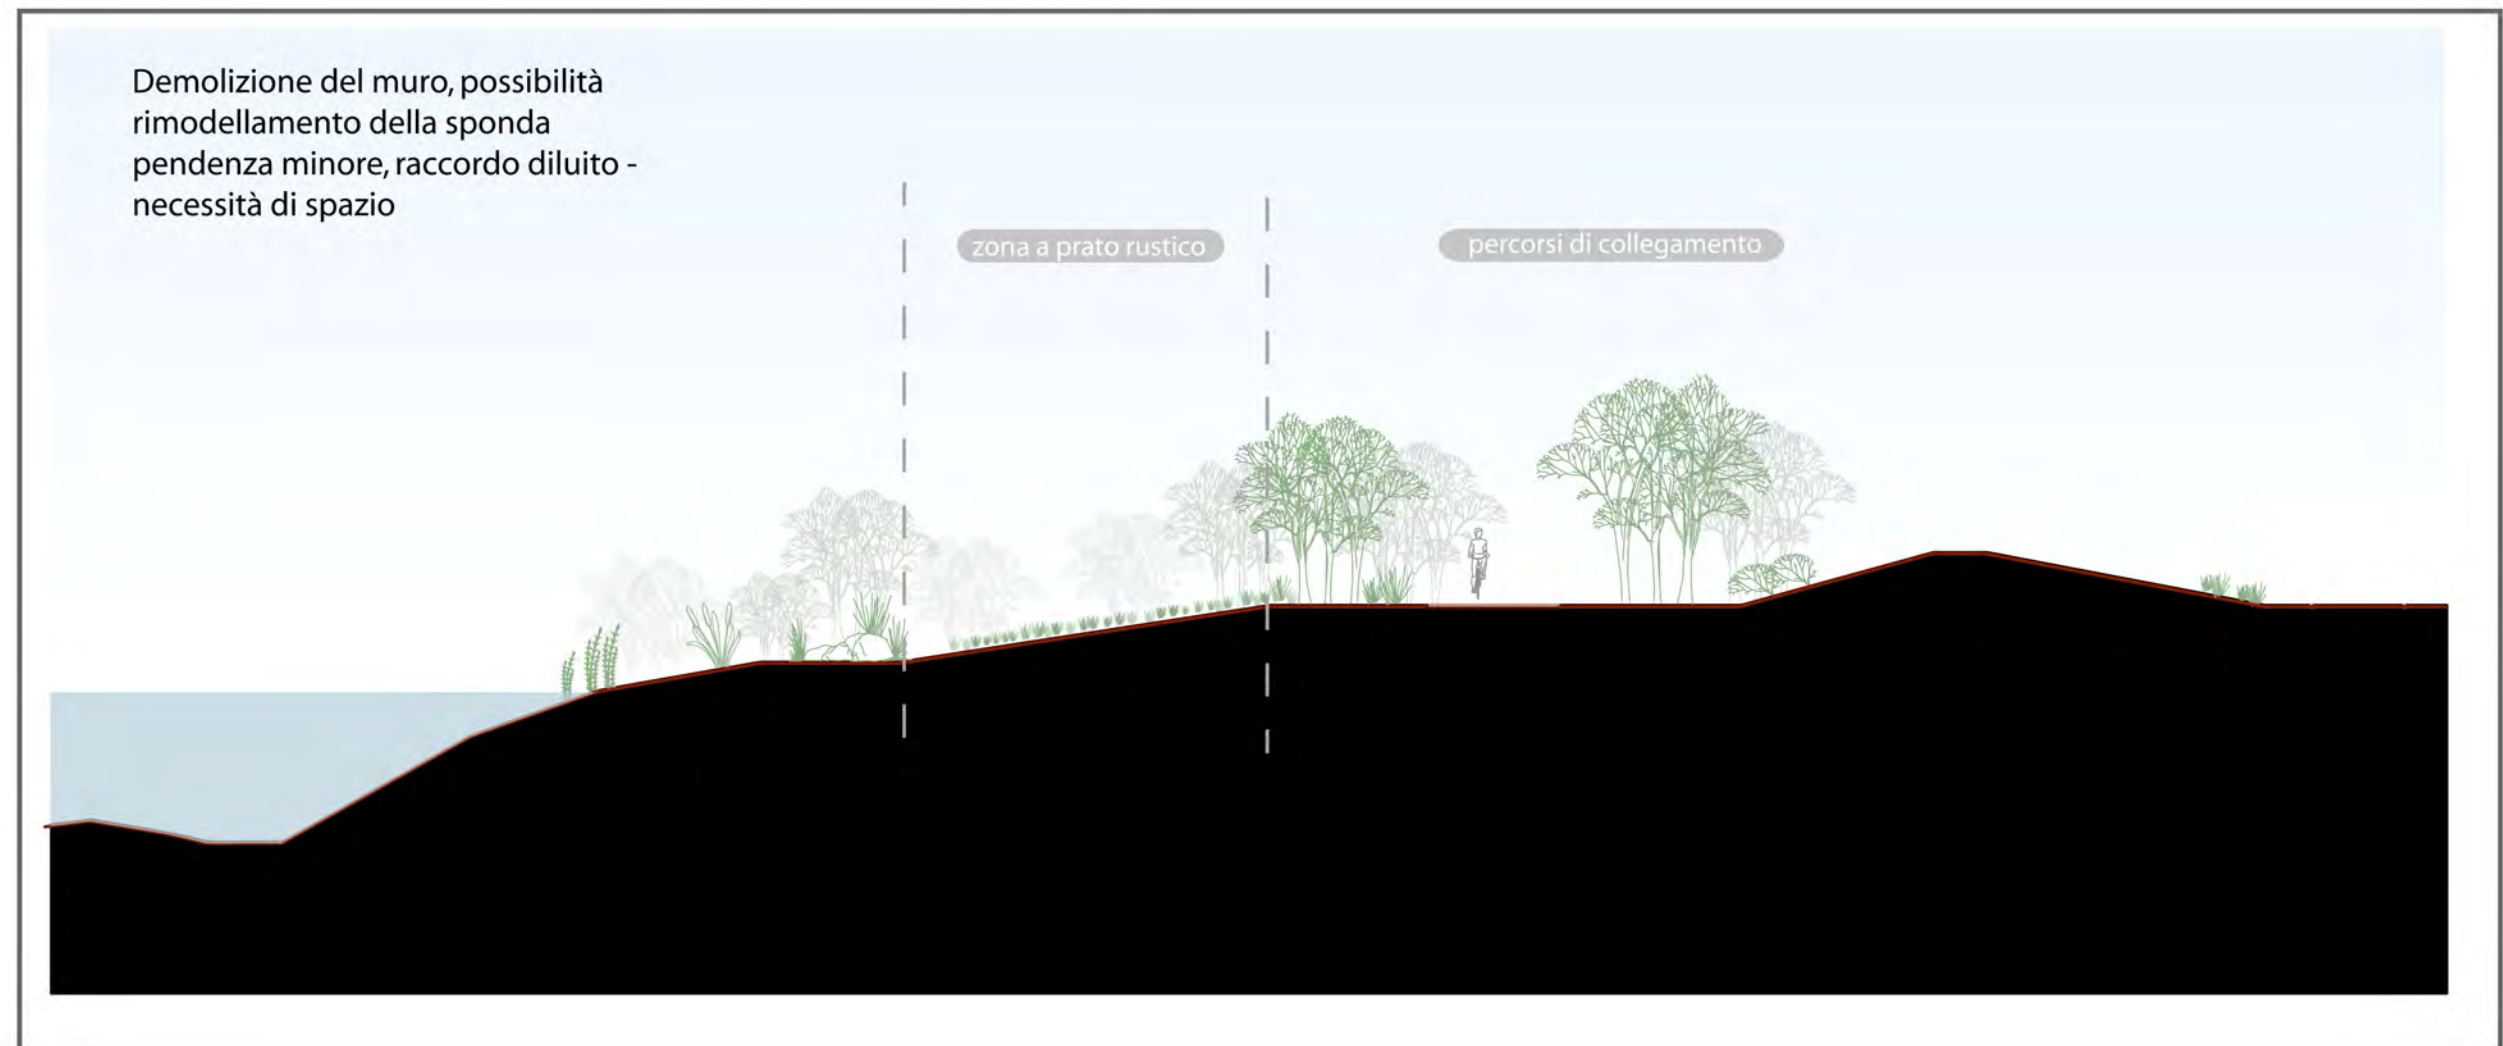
Caso 1.c con la demolizione del muro a retta.
